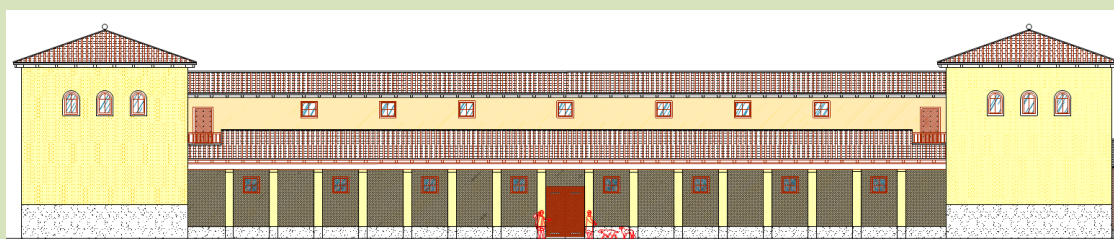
Ala norte, alzado de La Olmeda (reconstrucción virtual-I). CGS.
